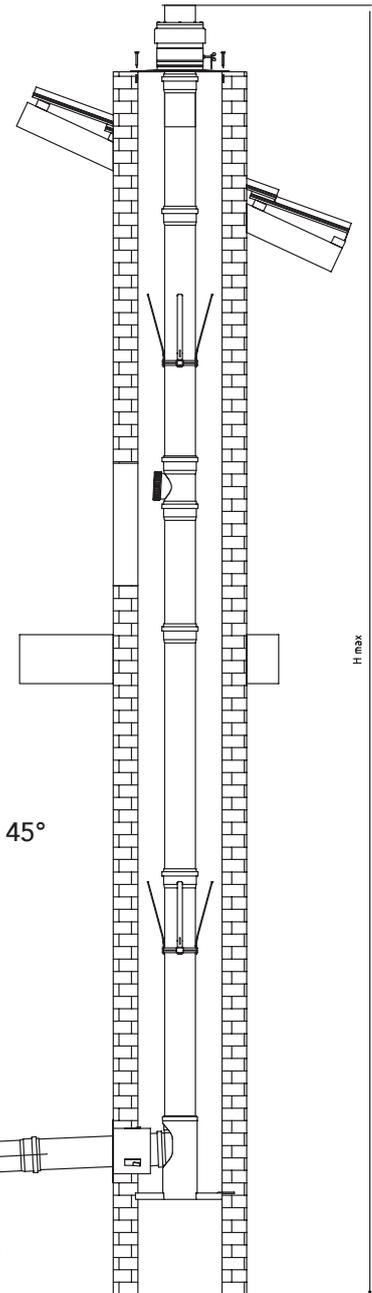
LAS 80/125 Außenwand mit Dachdurchführung
